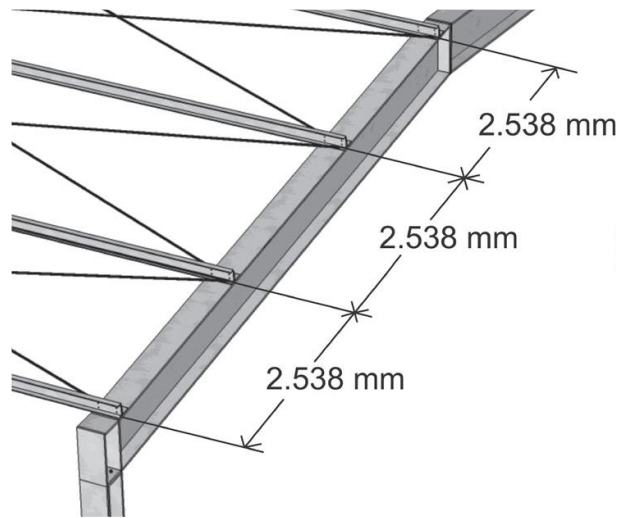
Espaçamento entre seções travadas no perfil da viga
